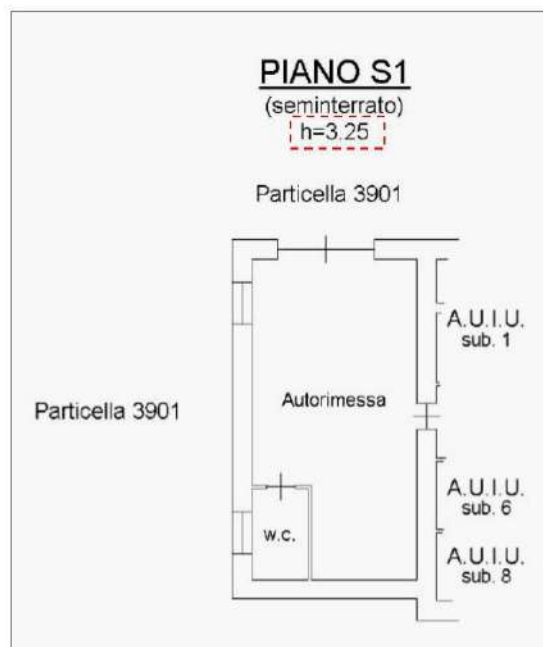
Planimetrica castale autorimessa (Sub. 2)
